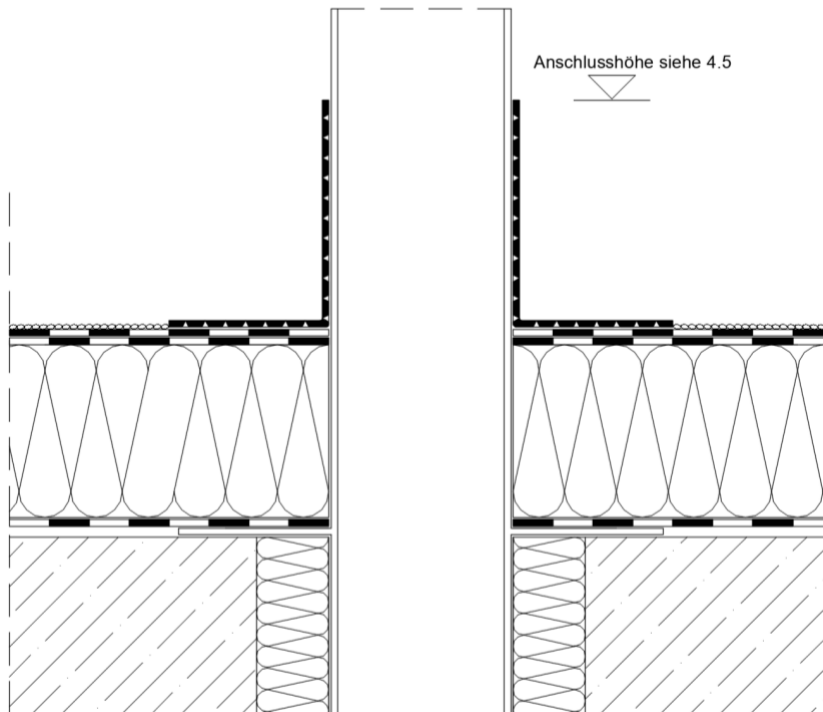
Dachablauf mit Aufstockelement – Ausführung mit Bitumenbahnen
